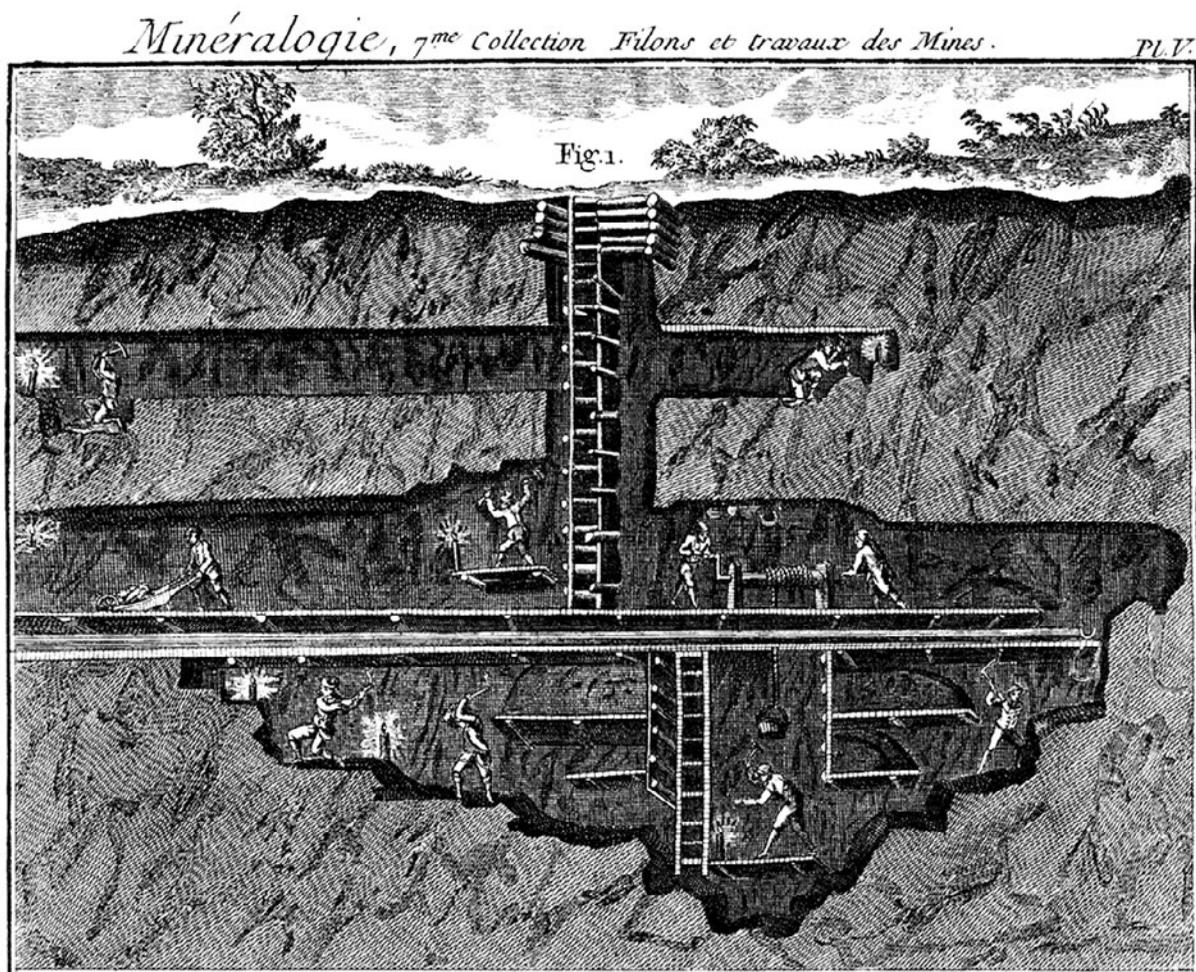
L'Encyclopédie, Art des Mines*, planche V.1, D. Briasson & F. Le Breton, Paris, 1753, sezione di uno scavo in profondità con la galleria principale di discesa e i cunicoli di escavazione mineraria.
